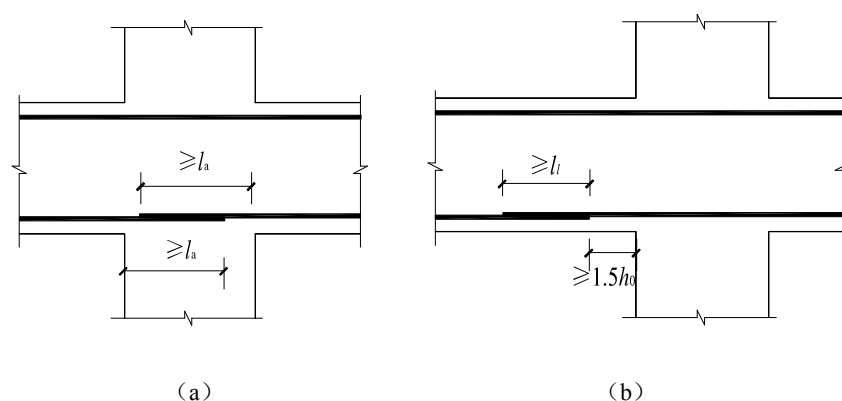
梁下部纵向钢筋在中间节点或中间支座范围的锚固与搭接
